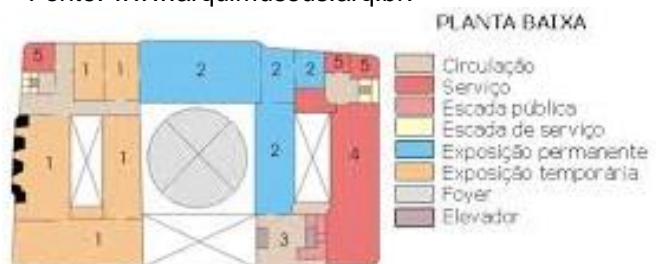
Planta Baixa 2º andar - Centro Cultural Banco do Brasil (1989), Arq. Luiz Telles.
